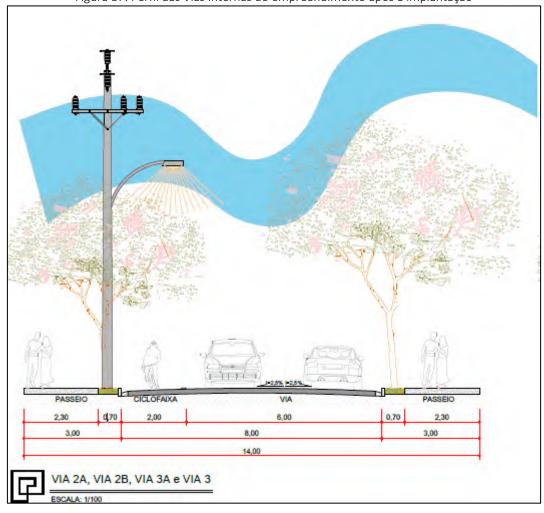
Perfil das Vias internas do empreendimento após a implantação
